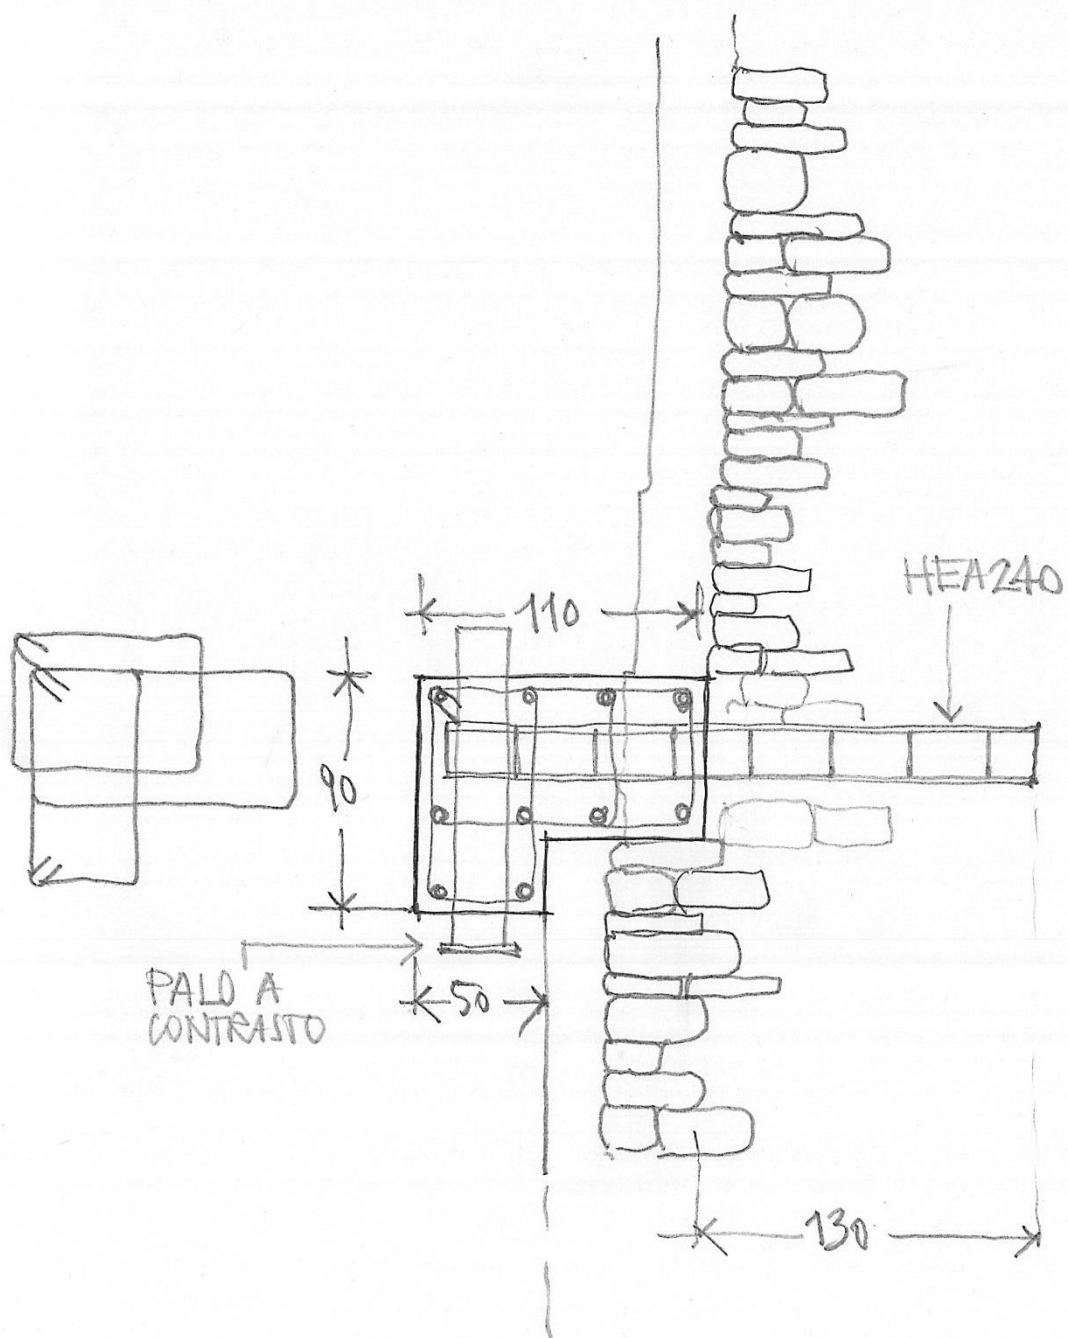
Sezione intervento fondale: trave di coronamento in c.a con profili in acciaio a mensola per sostenere il muro e applicazione dei pali infissi nel terreno.
